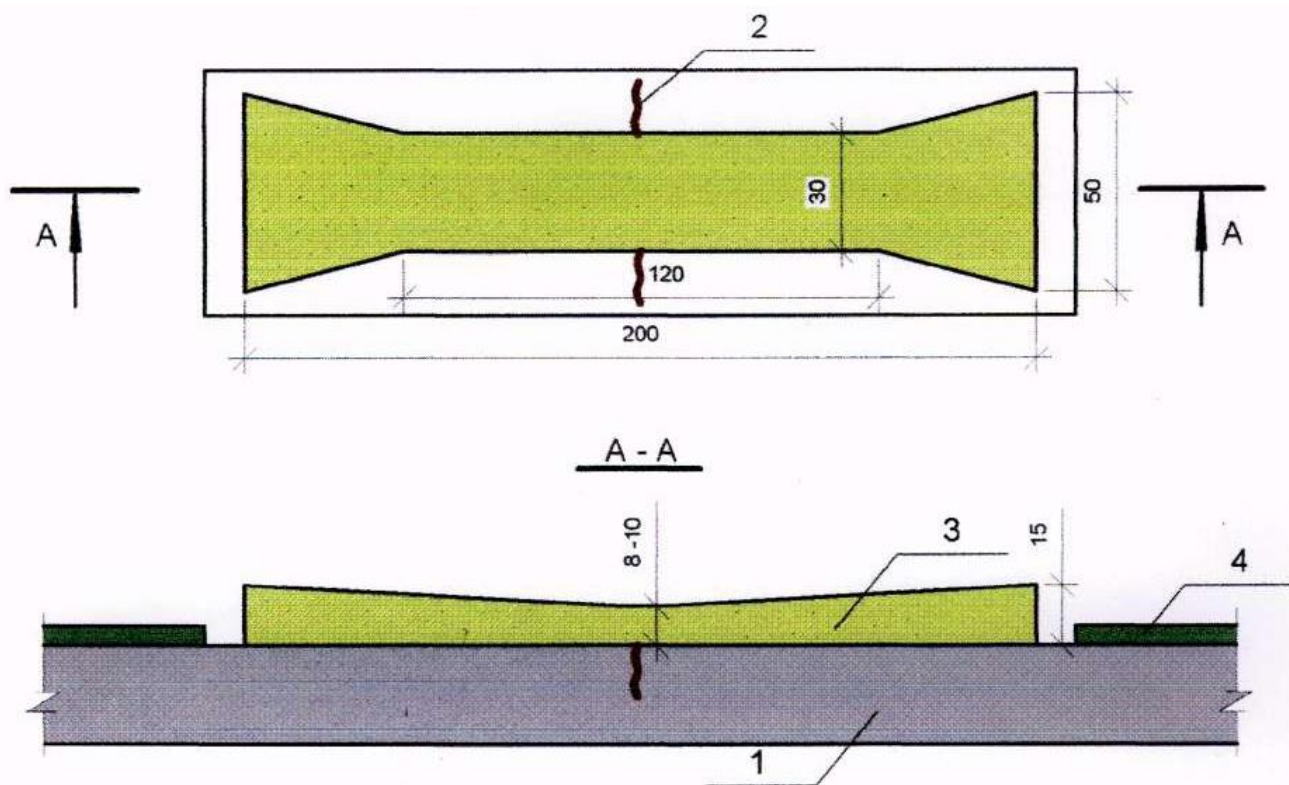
Конструкция плиточного маяка из гипса, алебастра или цементно-песчаного раствора:
